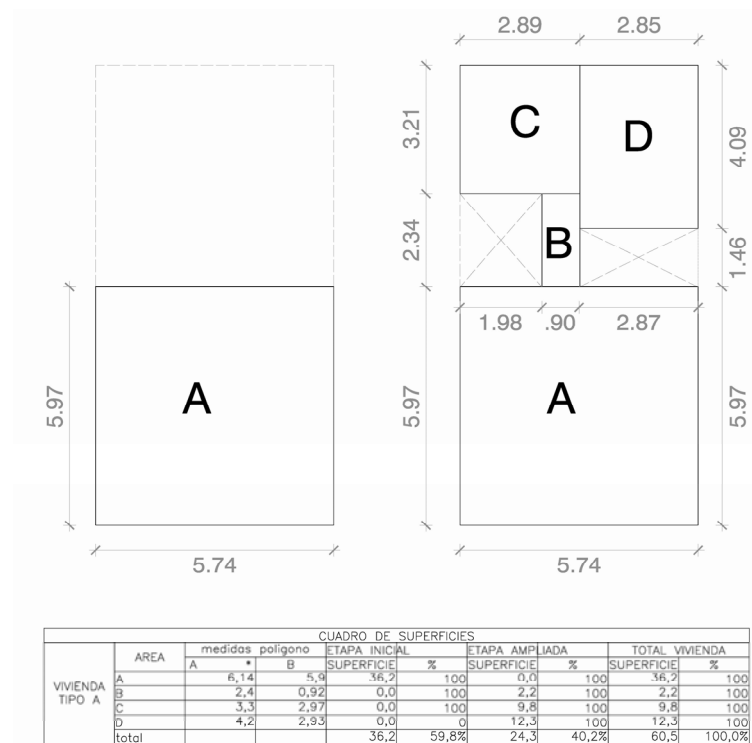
Cálculo de superficie construida vivienda Tipo A, Condominio Vista Alegre (2008)
